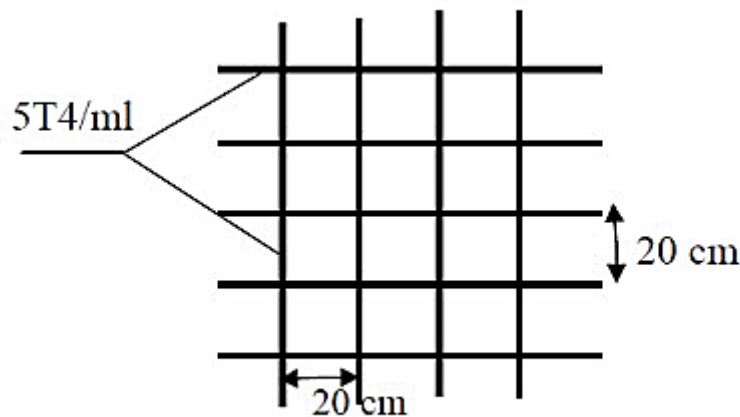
Schéma statique du ferrailage de la dalle de compression.
